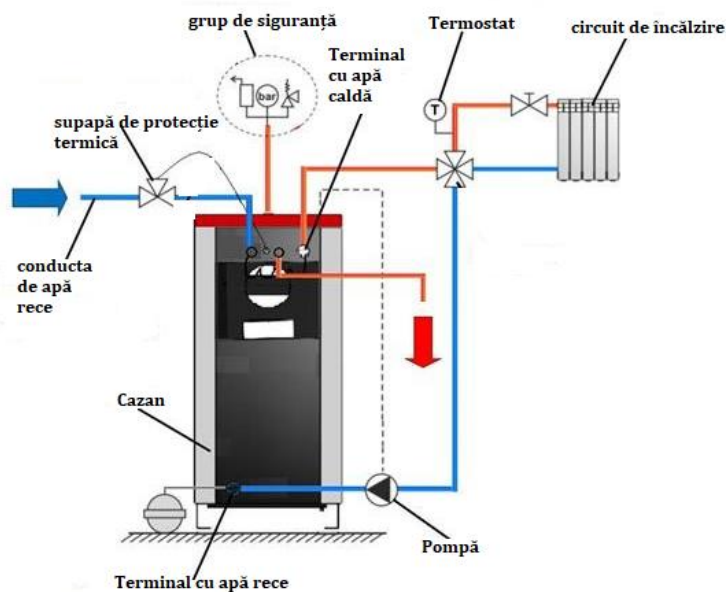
Schema de instalare a supapei de căldură cu conexiuni de 3/4"
